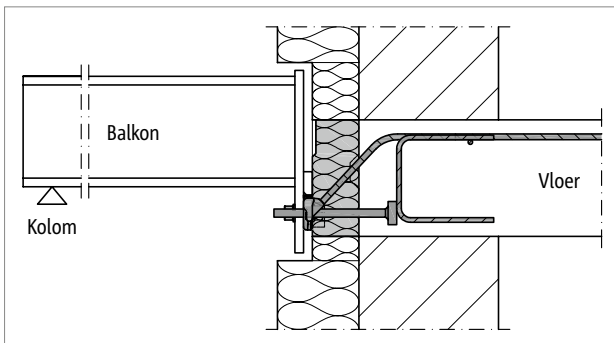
Schöck Isokorb® T type SQ: Ondersteund balkon
